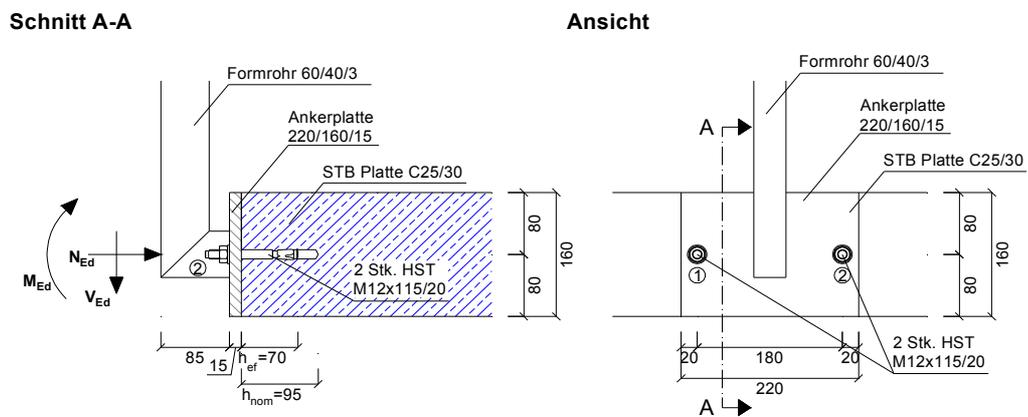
Anschlussdetail G2 Dübel Variante 1 (Maße in mm)
